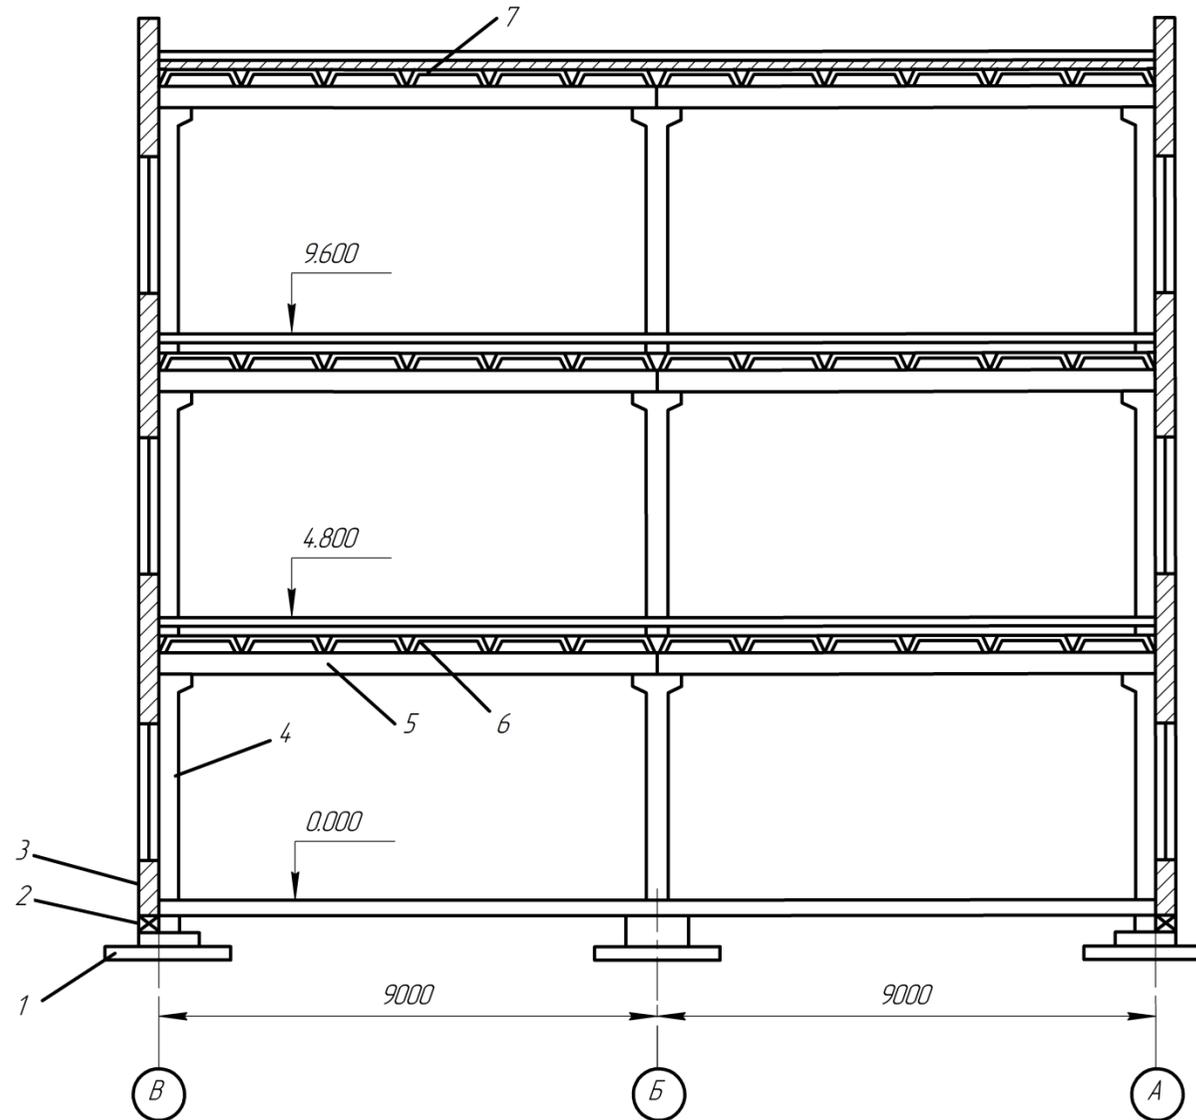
Поперечный разрез многоэтажного здания: 1 – фундамент; 2 – фундаментная балка; 3 – самонесущая стена; 4 – колонна; 5 – ригель; 6 – ребристая плита перекрытия; 7 – ребристая плита покрытия
